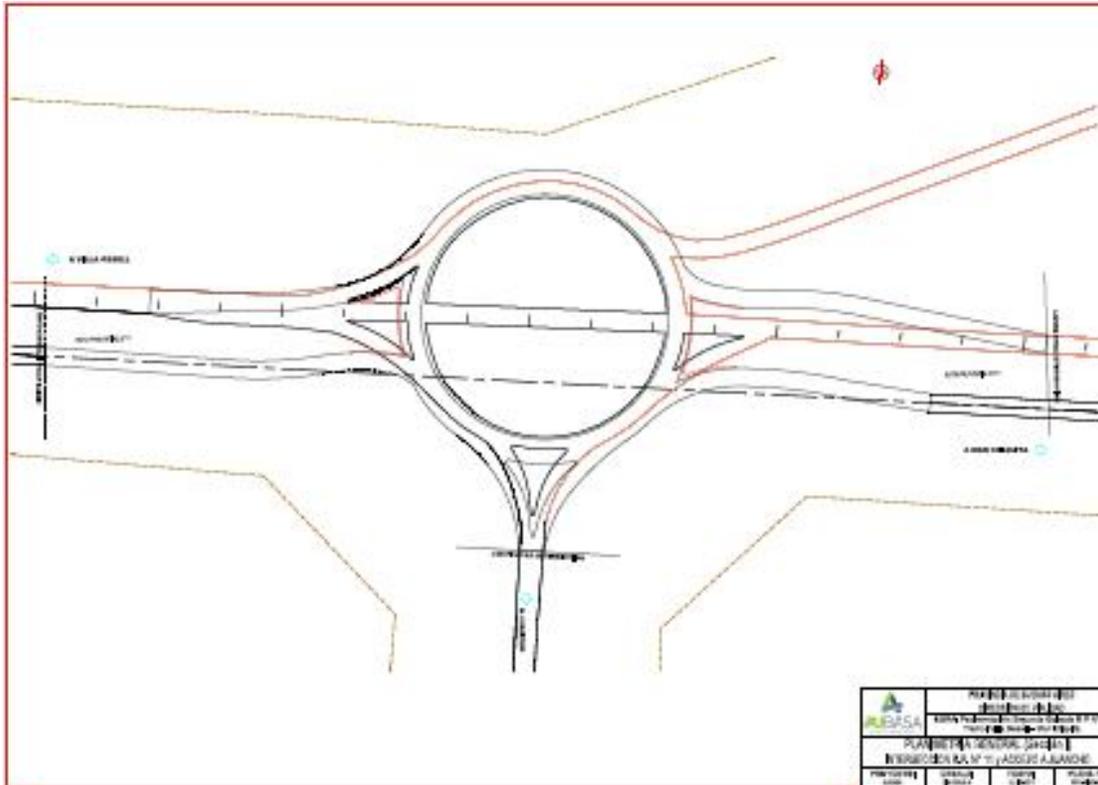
Planimetría Intersección RP N°11 y Acceso a Juancho
